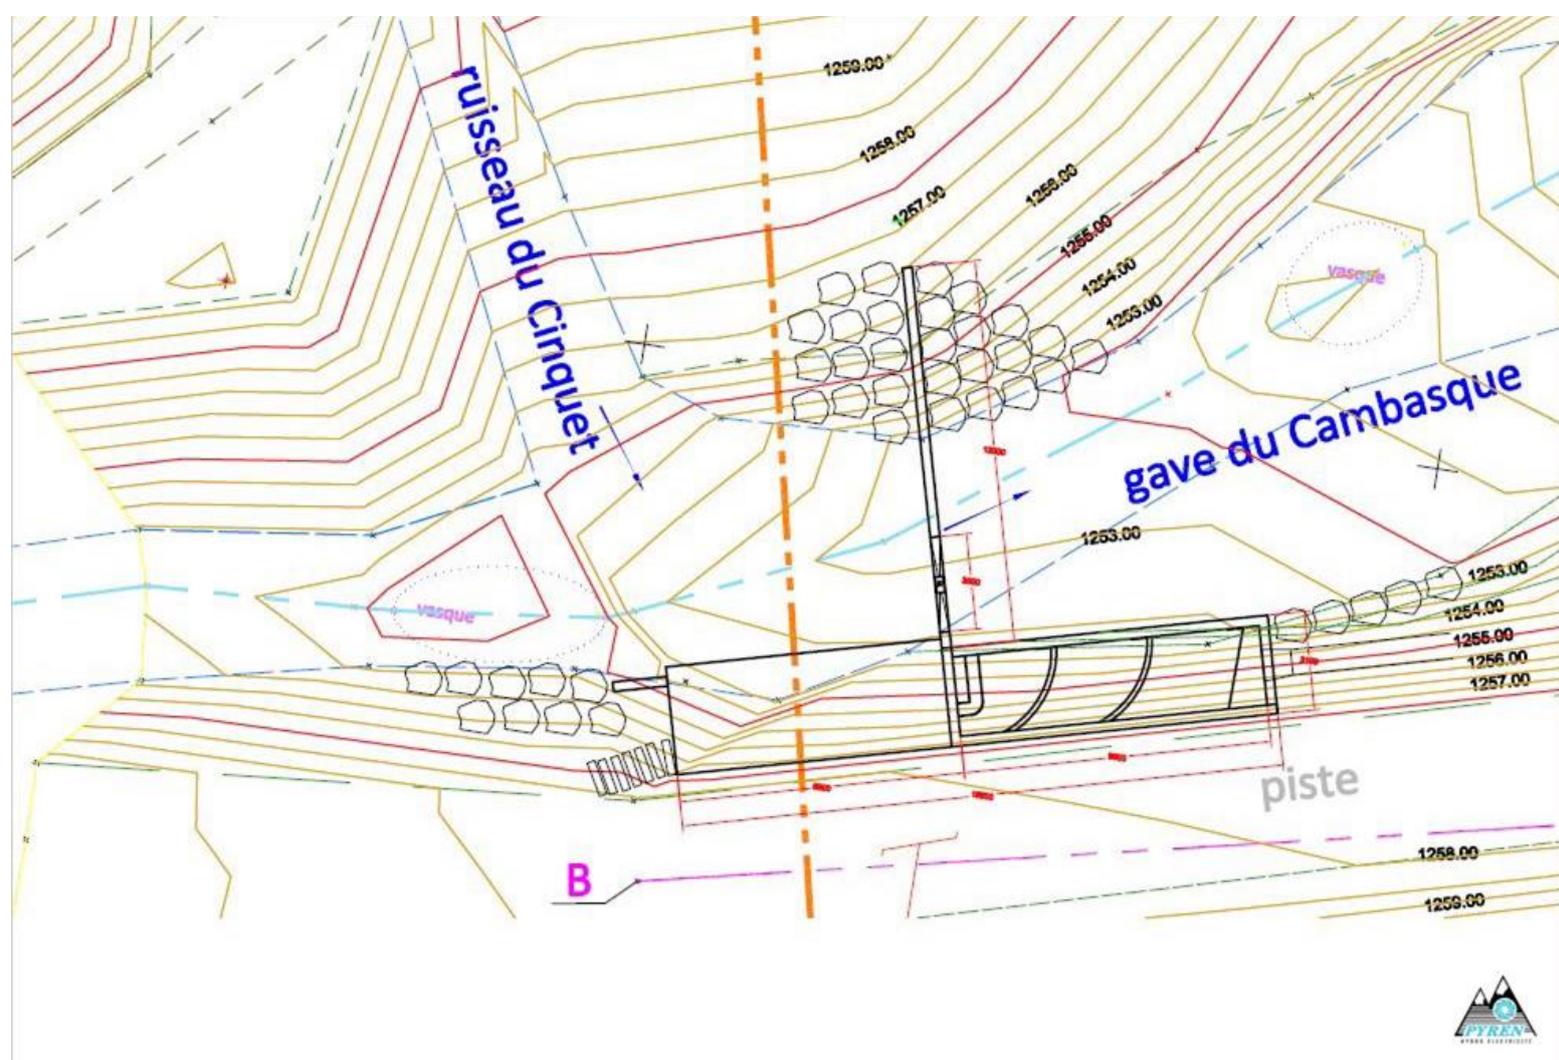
Plan d'encombrement général des ouvrages de prise d'eau sur relevé topographique des terrains (source : PYREN)
